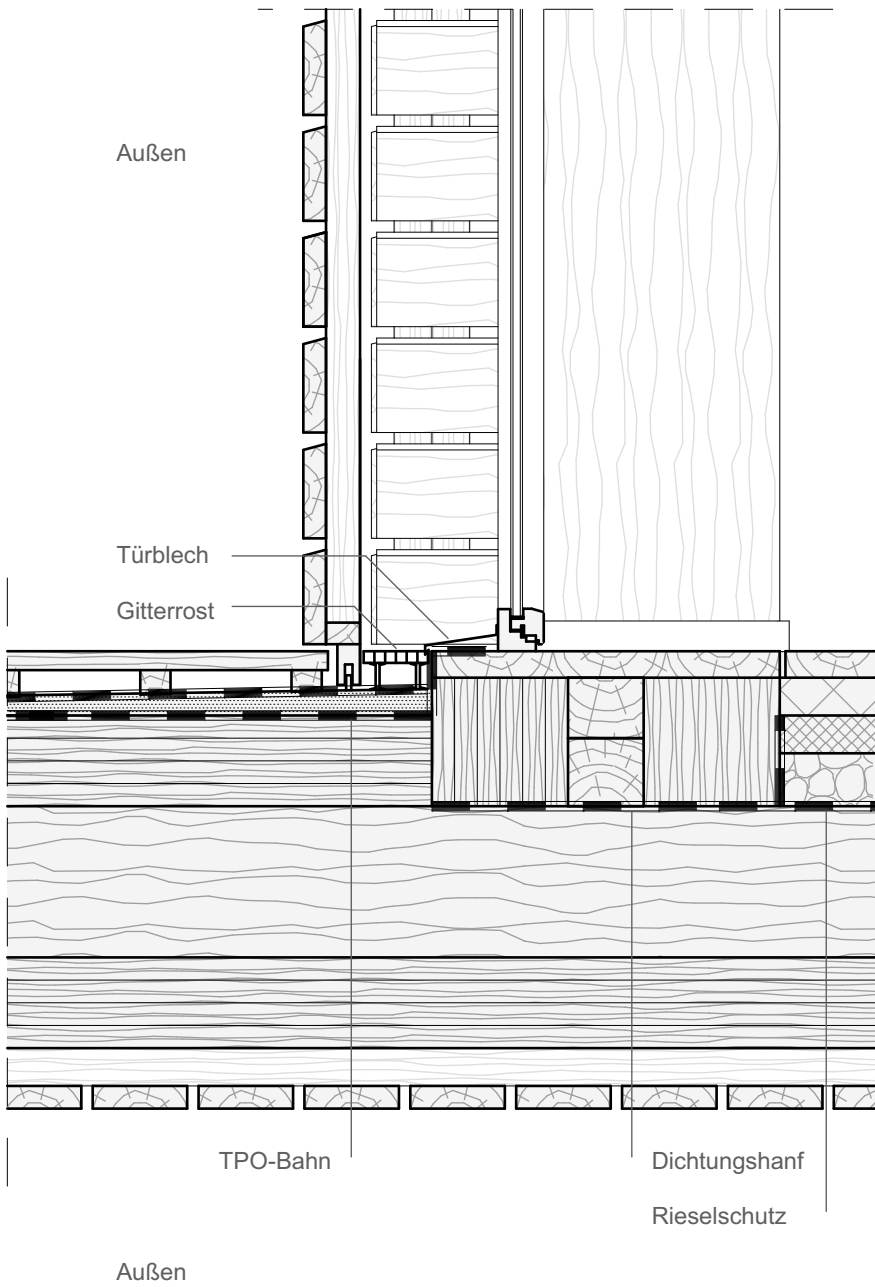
Balkon - Detail 3 M 1:10
